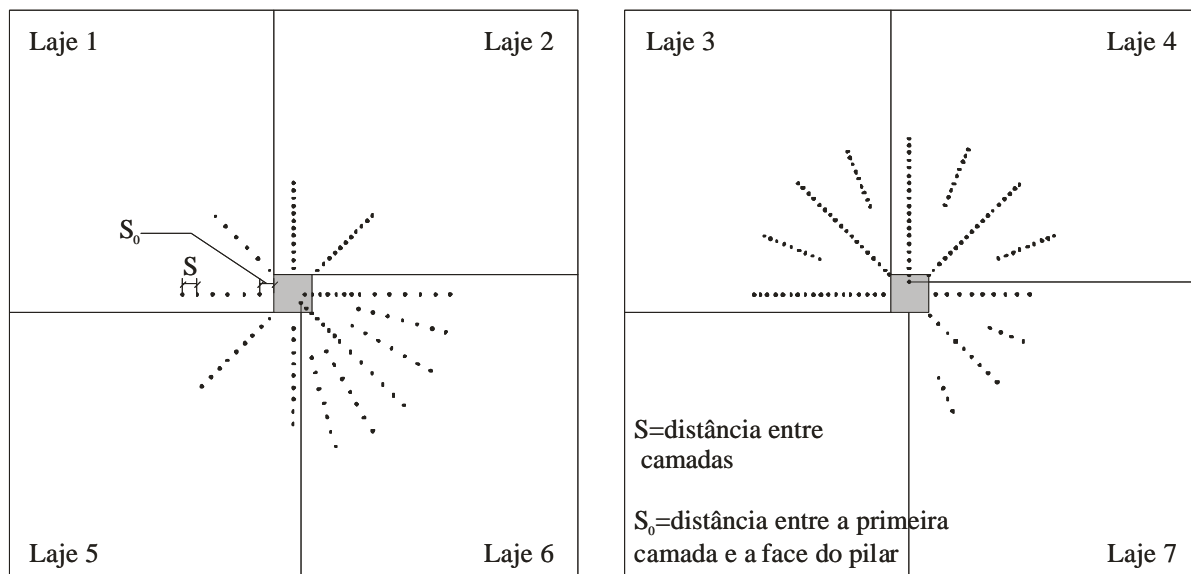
Disposição da armadura de cisalhamento – lajes de Andrade (1999)
